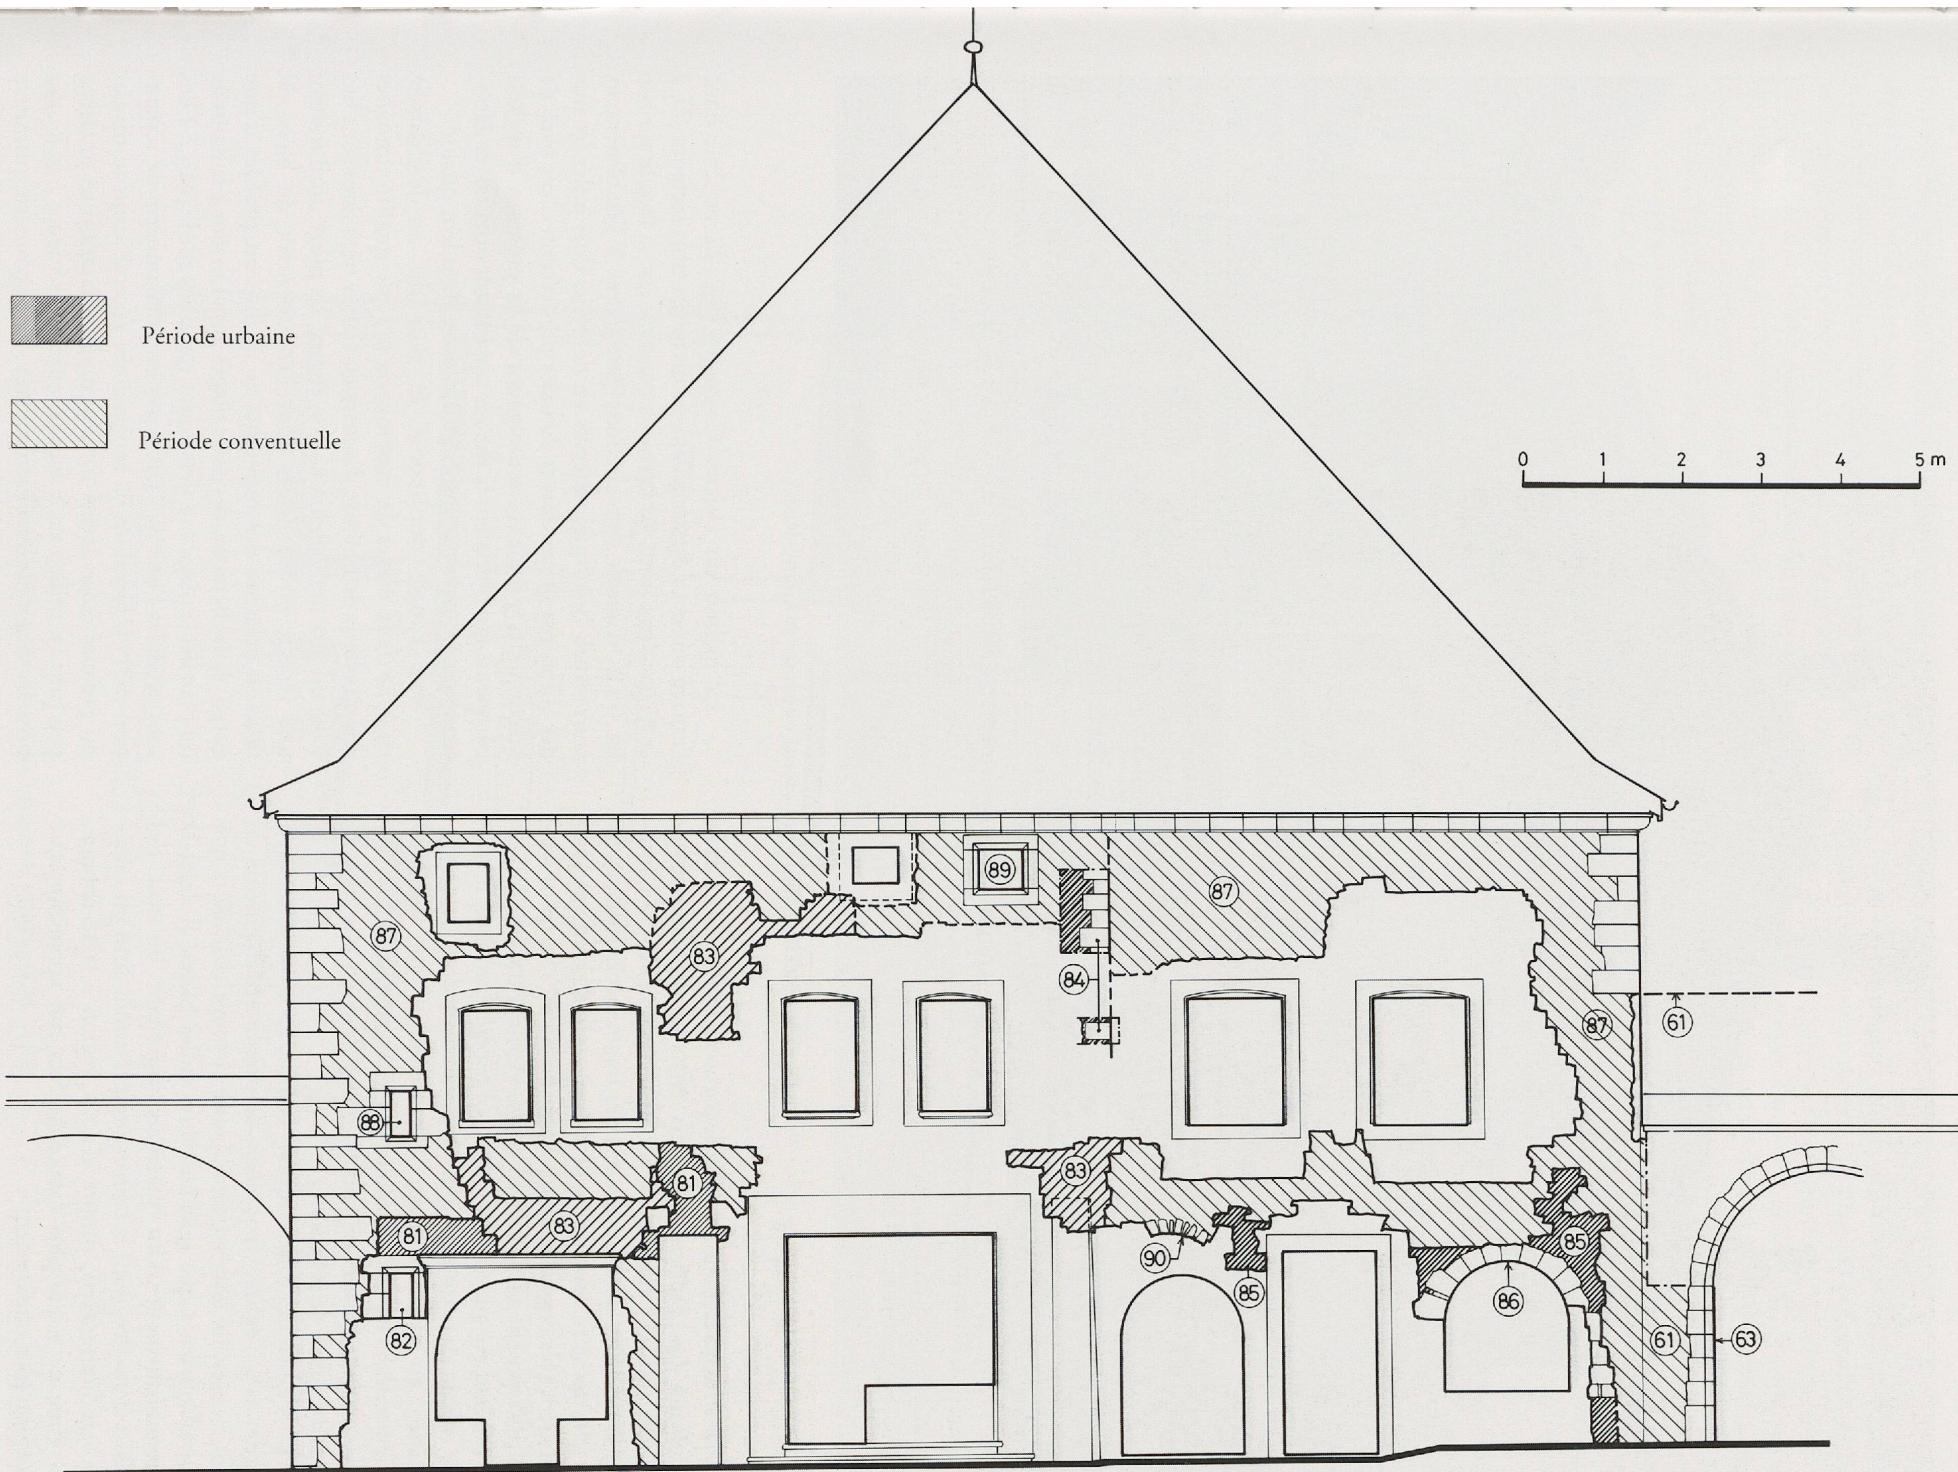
Le «Vieux Couvent», structures préconventionnelles et conventionnelles sur le mur de façade ouest. Ech.: 1:100.
